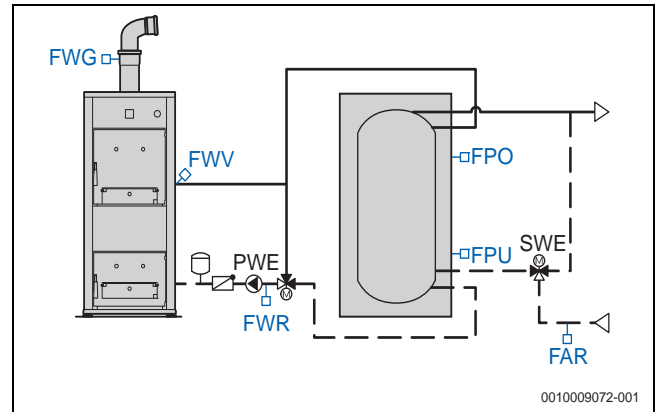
Manuelle Wärmeerzeuger – Start von Hand
